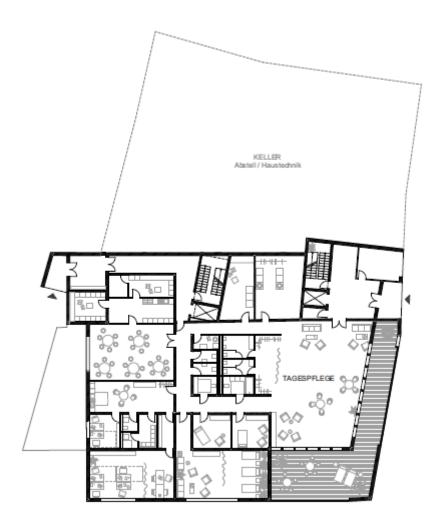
Grundriss 1. Untergeschoss (Mars-Architekten, 2020)
